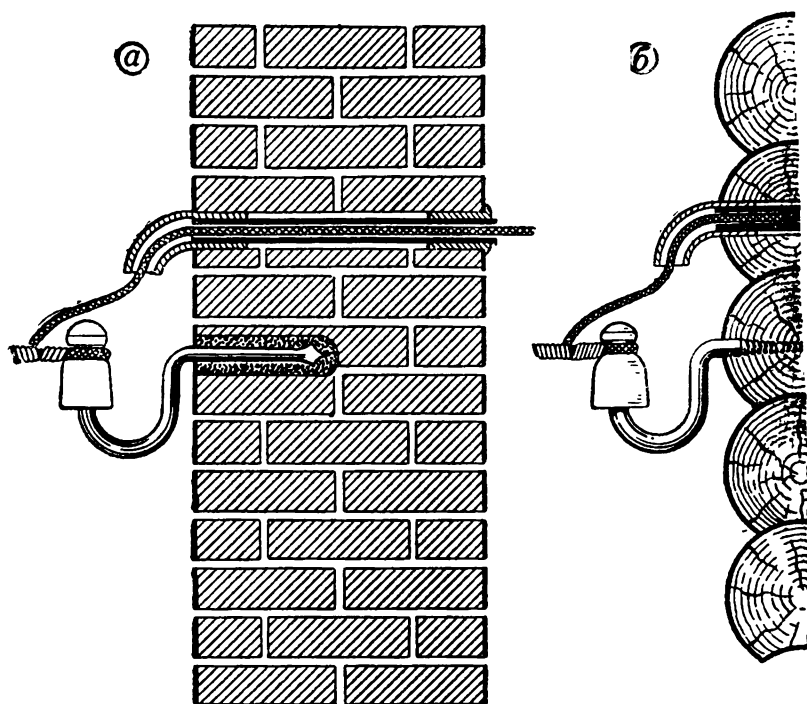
Ввод электропроводки в здание: а — через кирпичную стену; б — через деревянную стену.
